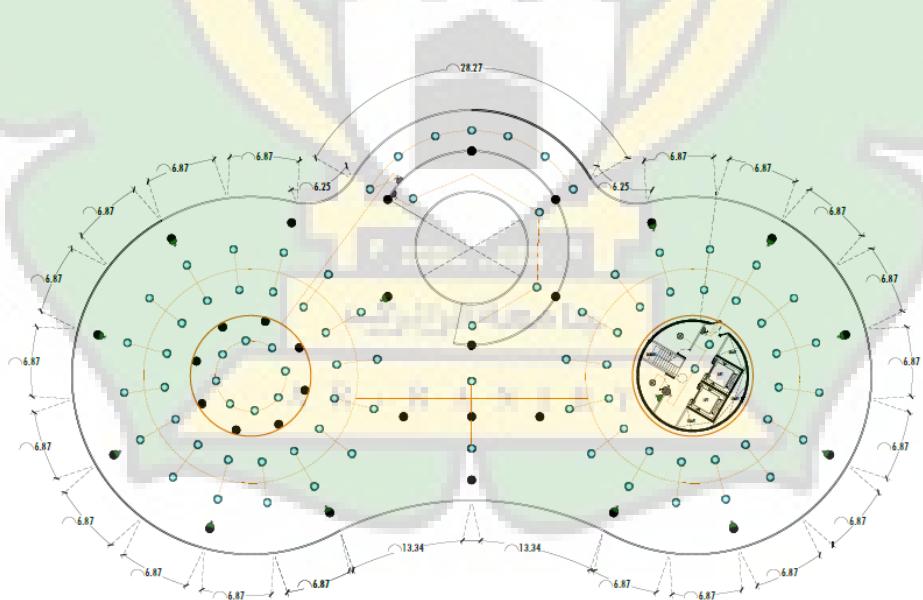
Denah Rencana Elektrikal Lantai 1
